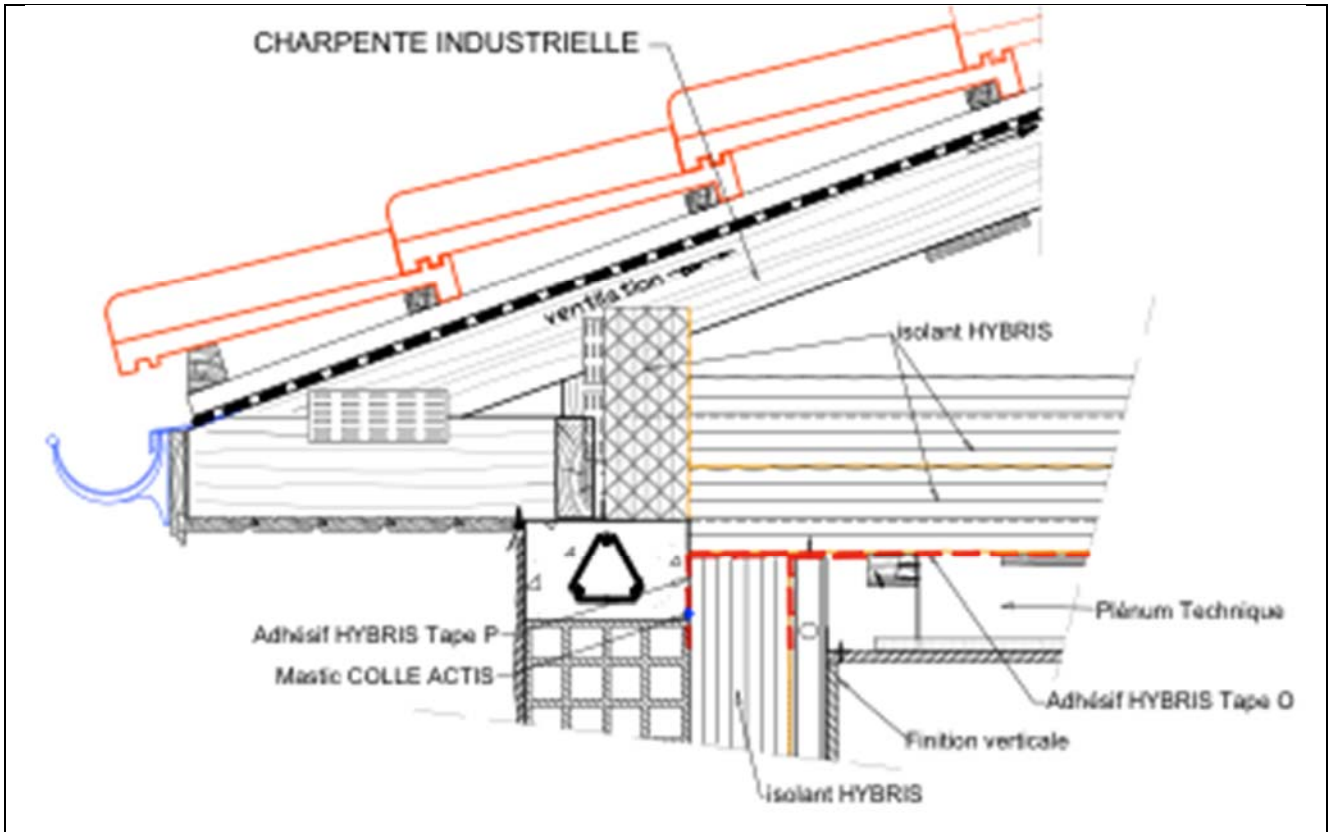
Pose horizontale de l'isolant en combles sur plancher bois, avec écran de sous-toiture – Traitement de la panne sablière
